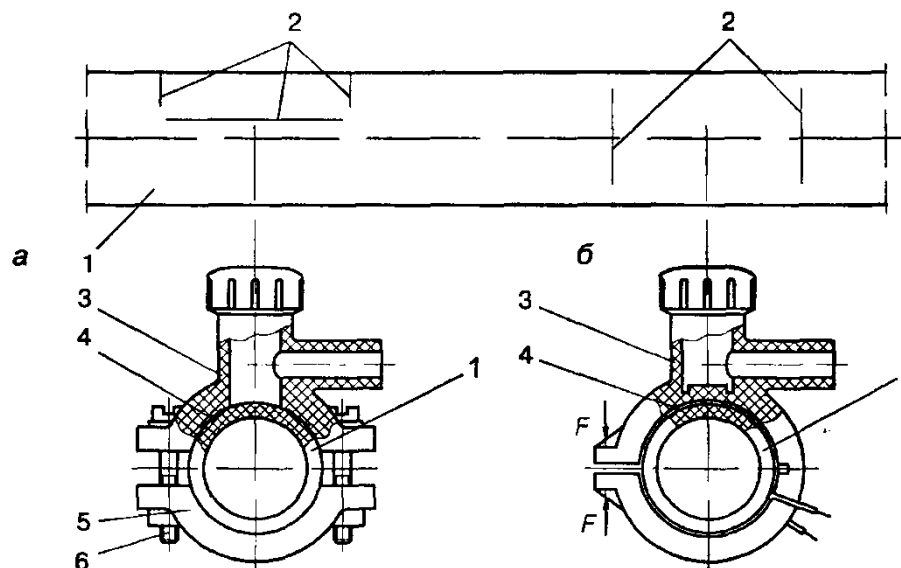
Соединение п/э трубы и отводов с закладными нагревателями
